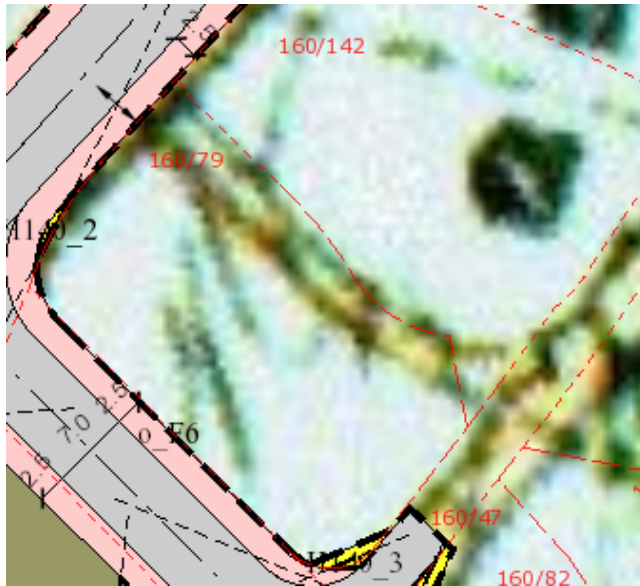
Utsnitt fra regulert situasjon, planområdet i turkist omriss
